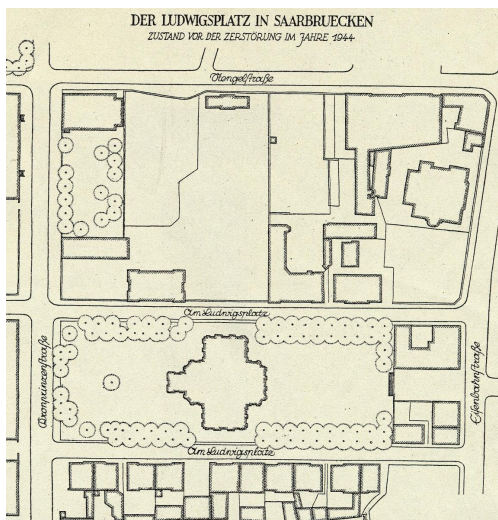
Saarbrücken. Ludwigplatz. Lageplan vor 1944.
